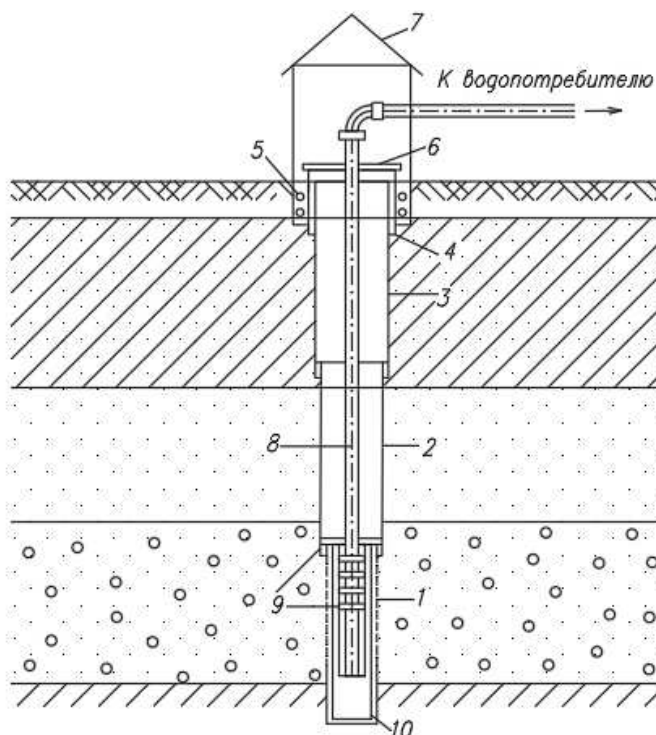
Конструкция скважины: 1 – фильтр скважины; 2 – эксплуатационная колонна труб; 3 – колонна обсадных труб; 4 – кондуктор; 5 – затрубная цементация; 6 – устье скважины (оголовок); 7 – павильон (шатер); 8 – насосные (водоподъемные) трубы; 9 – насос с погружным электродвигателем; 10 – отстойник; 11 – статический уровень грунтовых вод;
